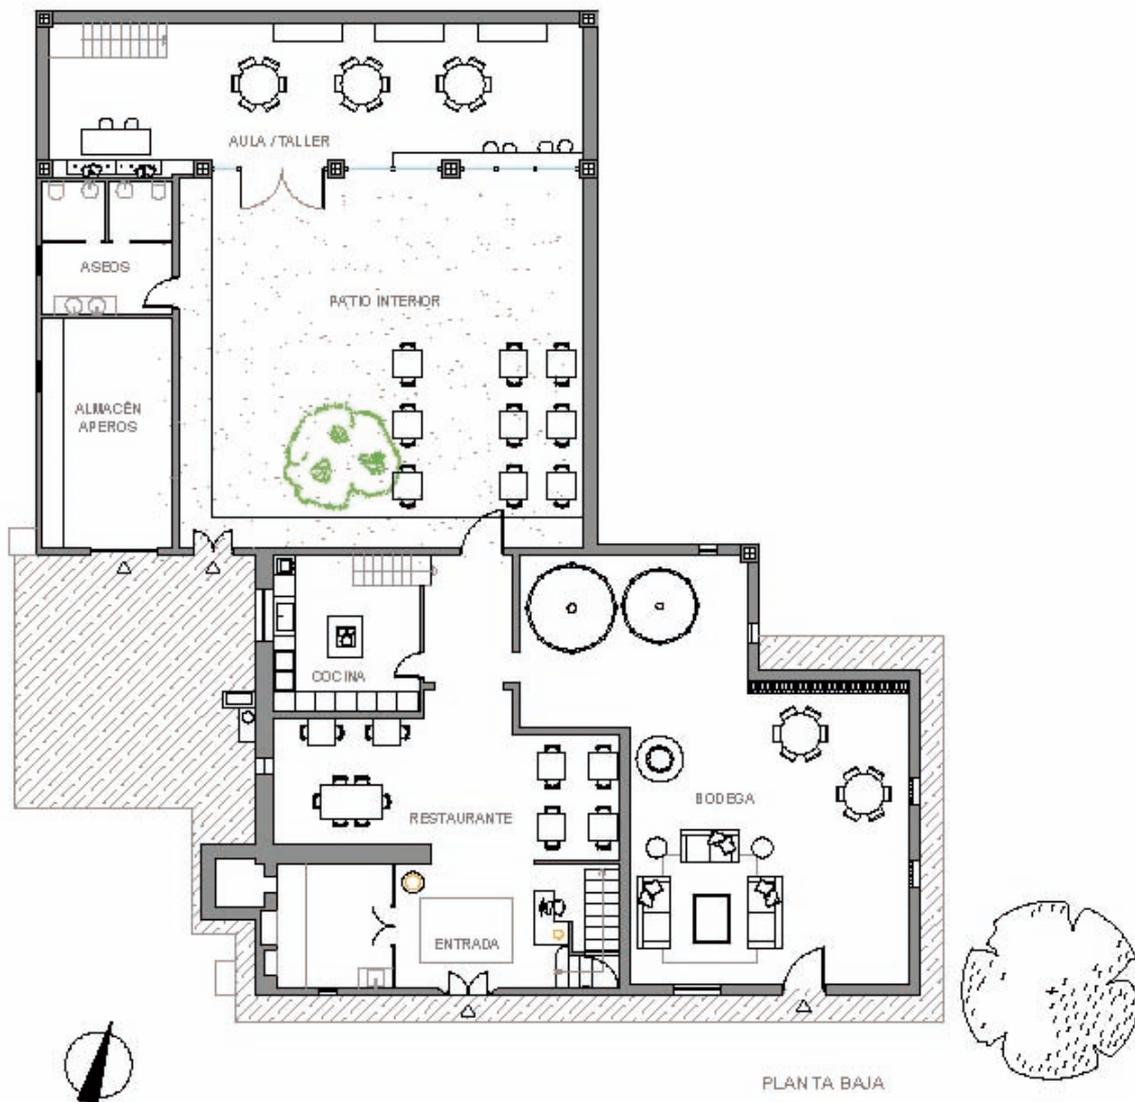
Plano de planta baja Cambio de uso Caseta Bas. Fuente Propia. 2016
